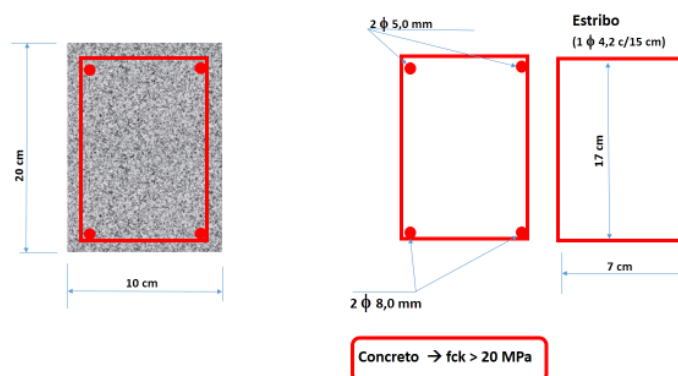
detalhe da viga reforçada em aço(corte transversal))
